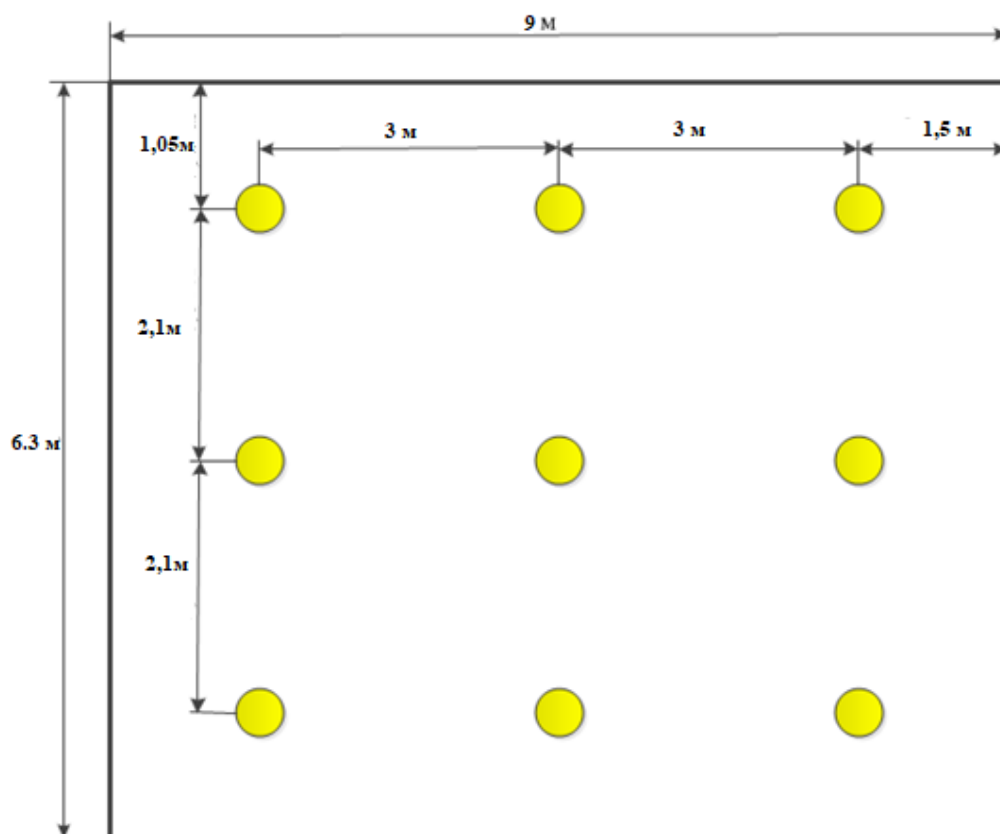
План размещения светодиодных ламп в кабине судна
